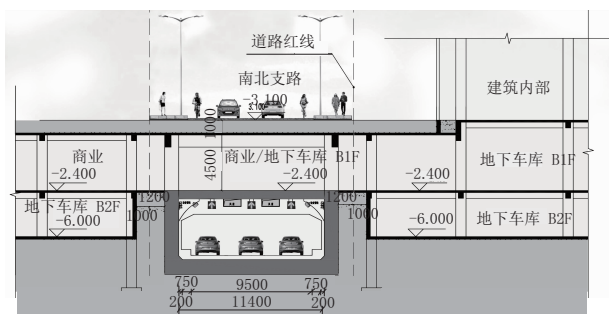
地块B1层地下商业段衔接横断面图(单位:mm)
